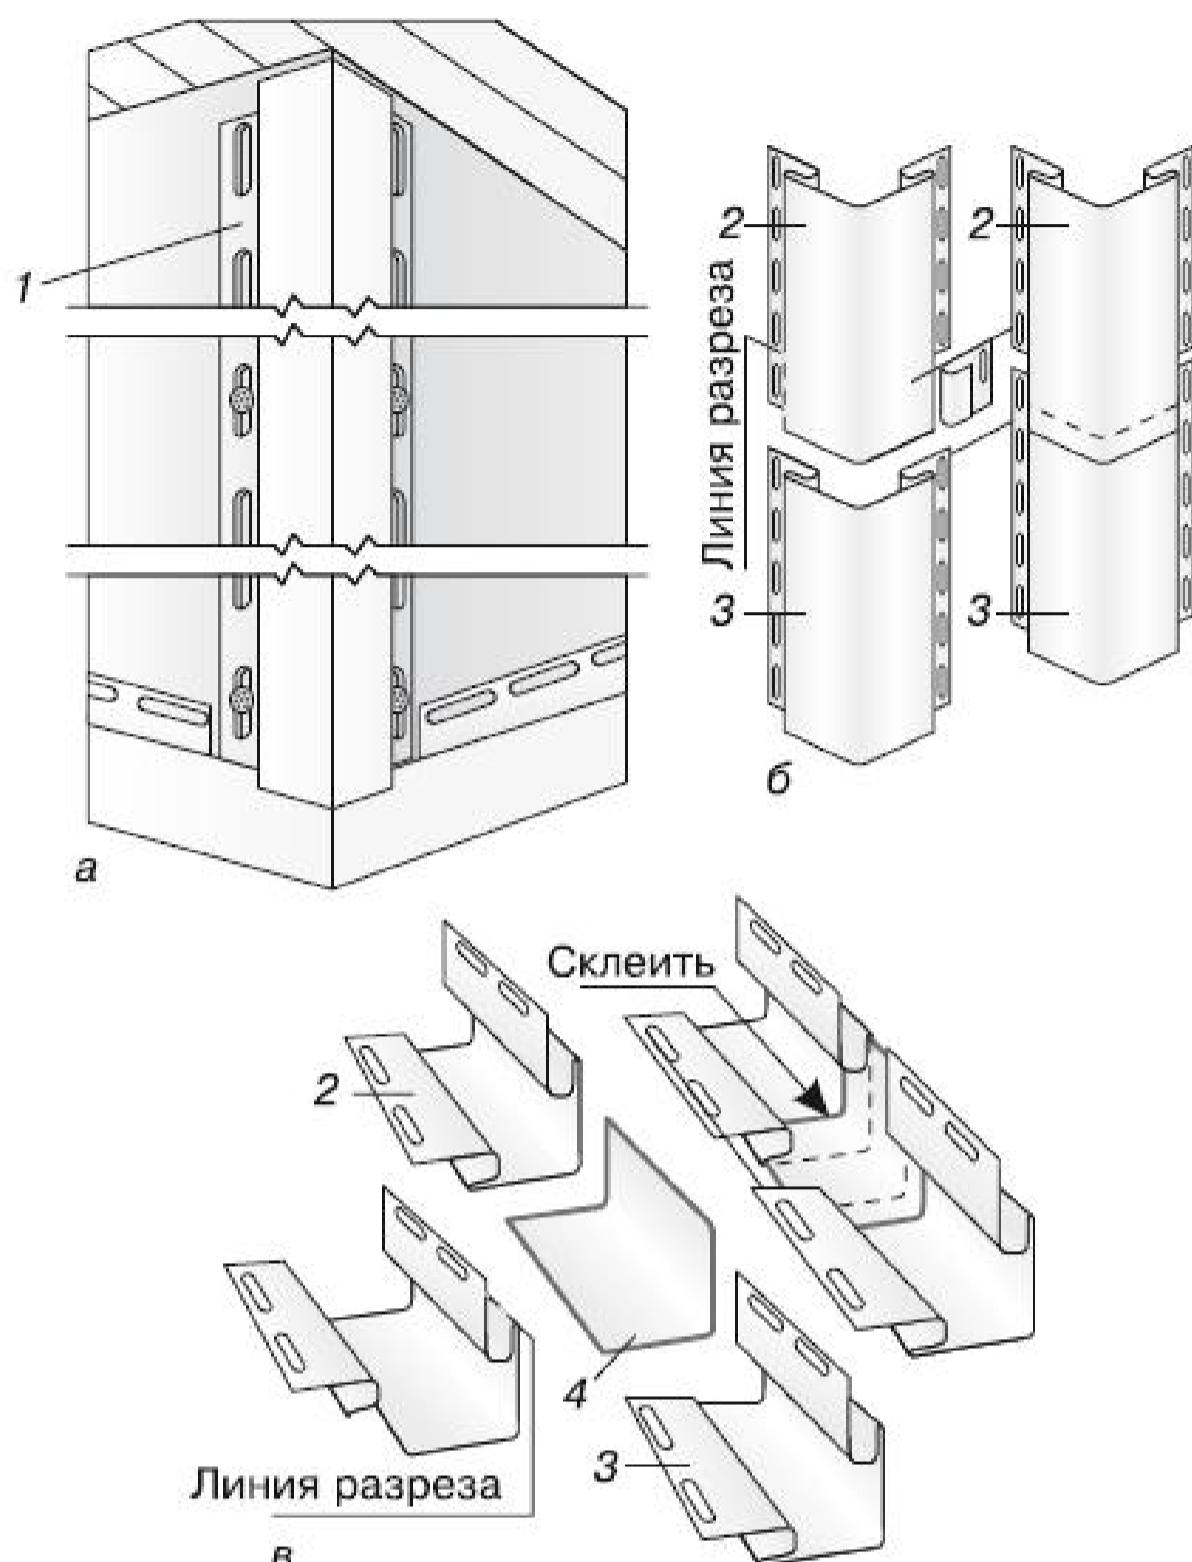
Монтаж угловых профилей: а – общий вид; б –стыкование угловых профилей внахлест; в – то же через накладку на клею; 1 – наружный угловой профиль; 2 – верхняя панель; 3 – нижняя панель
